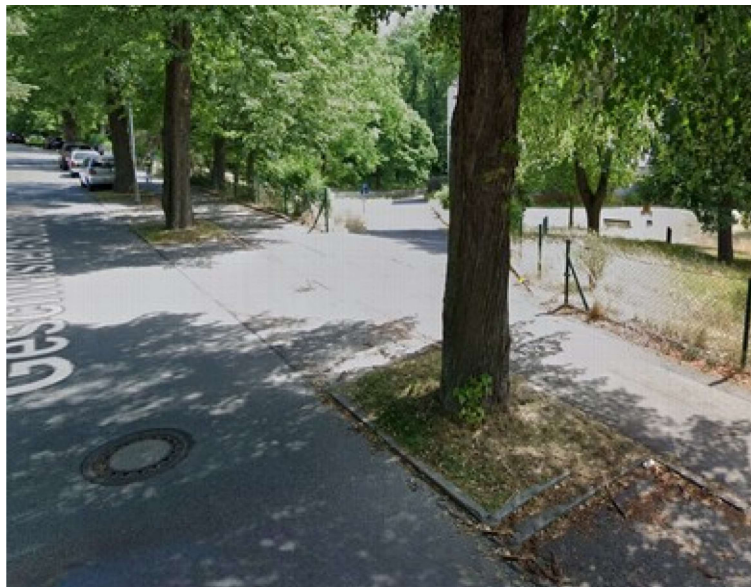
Baustelleneinfahrt Geschwister-Scholl-Straße
